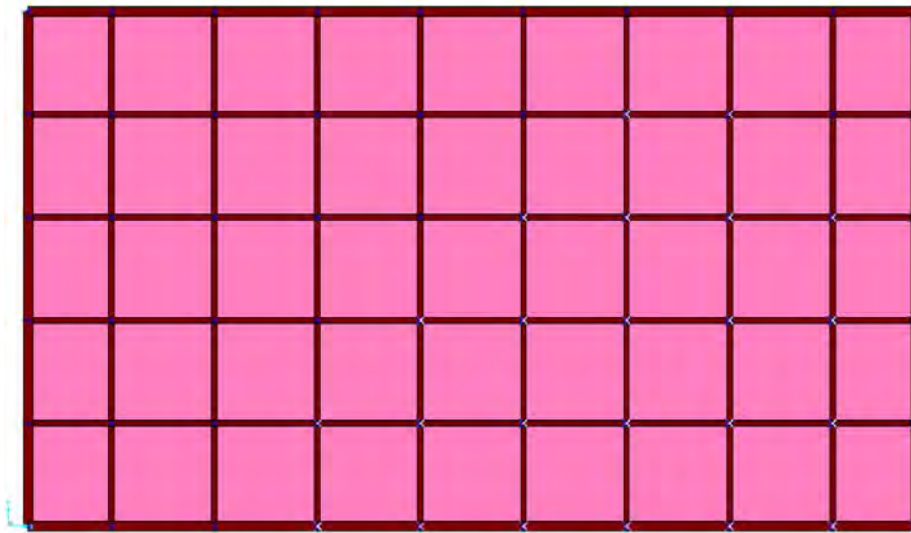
Vista en planta del cajón con celdas rectangulares con los espesores
